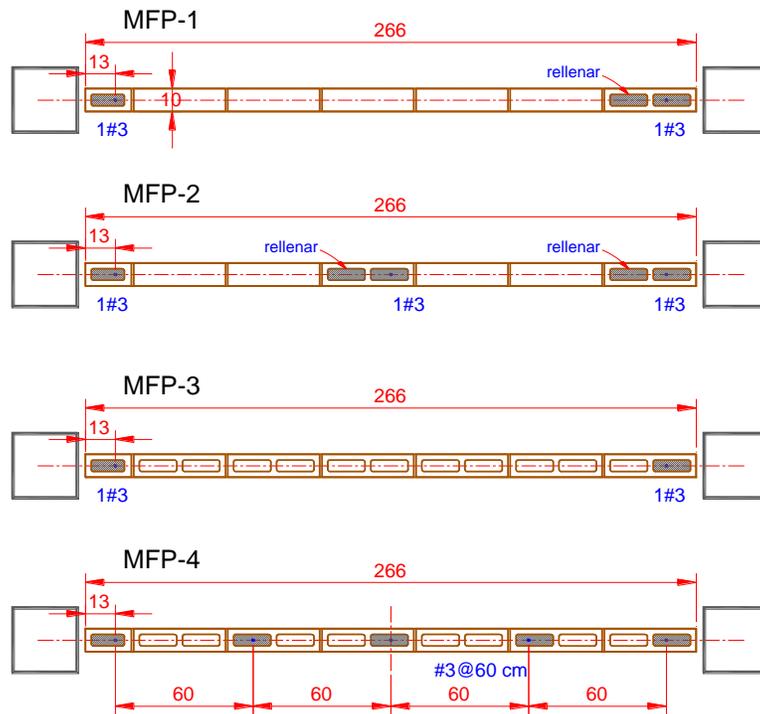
Sección de los muros dentro del marco de concreto, MFP-1 a 4
